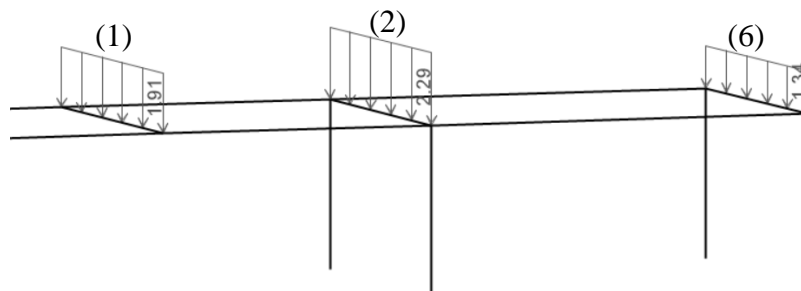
Sobrecarga nas Travessas do Troço Horizontal
